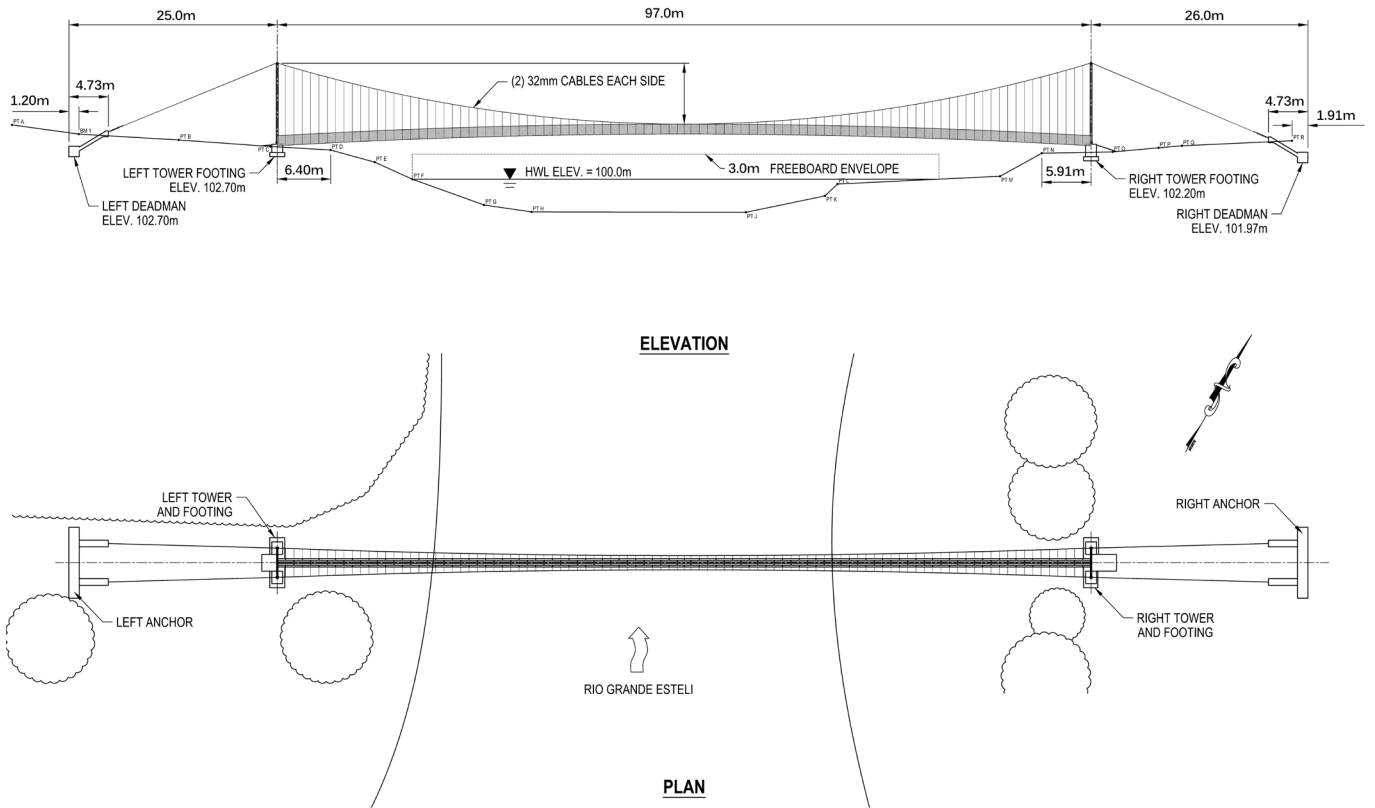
Alzado y planta general de la Pasarela Monte Verde.
